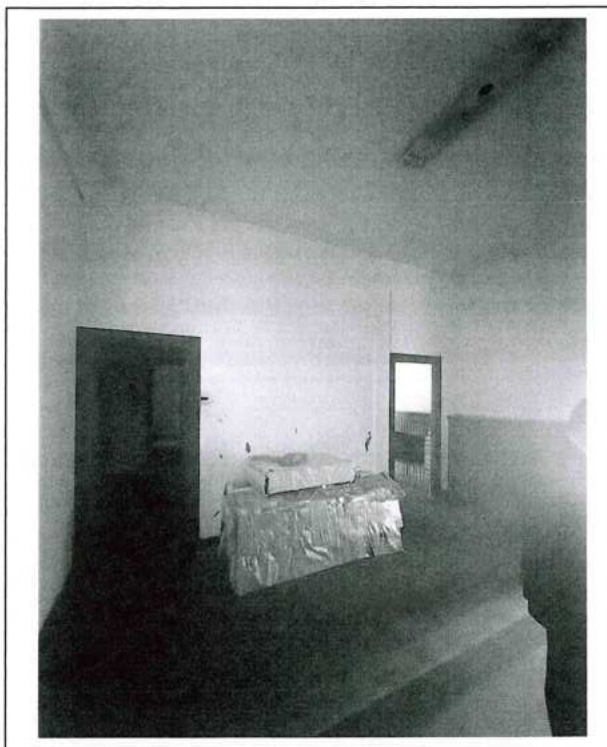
IMAGEN . MUROS DE DRYWALL EXISTENTES CON ACABADO PINTADO EN SEGUNDO NIVEL ZONA DE HALL.
